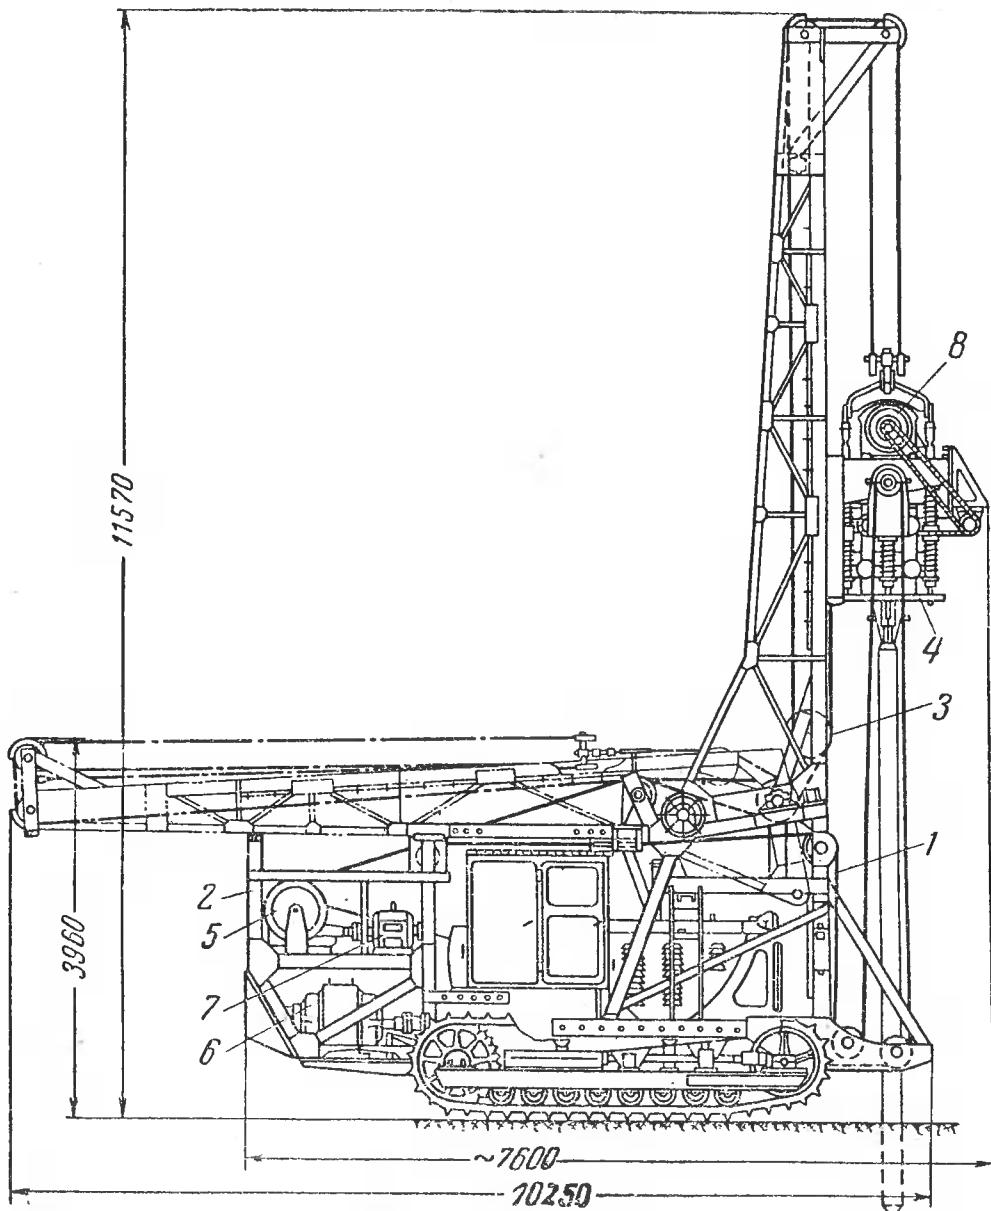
Общий вид вибровдавливающего агрегата ВВПС-20/11.
